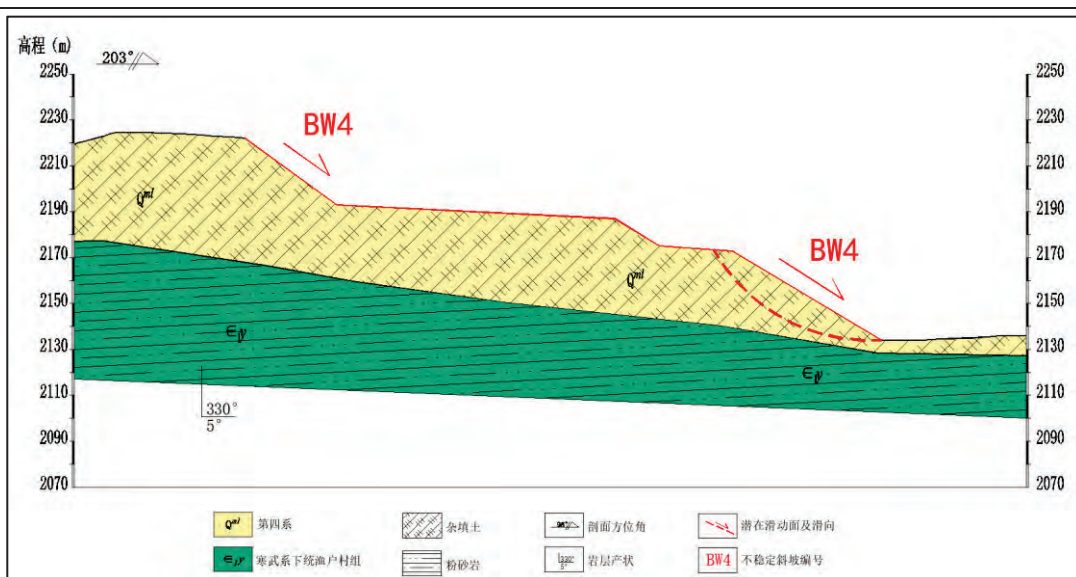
BW₄ 不稳定边坡地质剖面图
